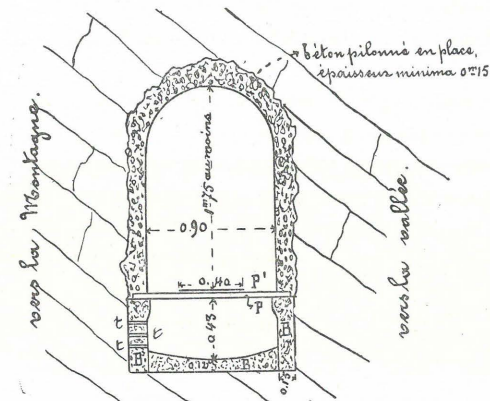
Section-type d'une galerie de captage. Coupe transversale. — B, B, B, blocs de béton rapportés. — t, t, t, trous dans les blocs placés du côté de la montagne pour l'entrée de l'eau dans la galerie. — P, poutrelles à 4^k.50 le mètre courant espacées d'environ 0^m.50. — P' plancher en tôle striée.
